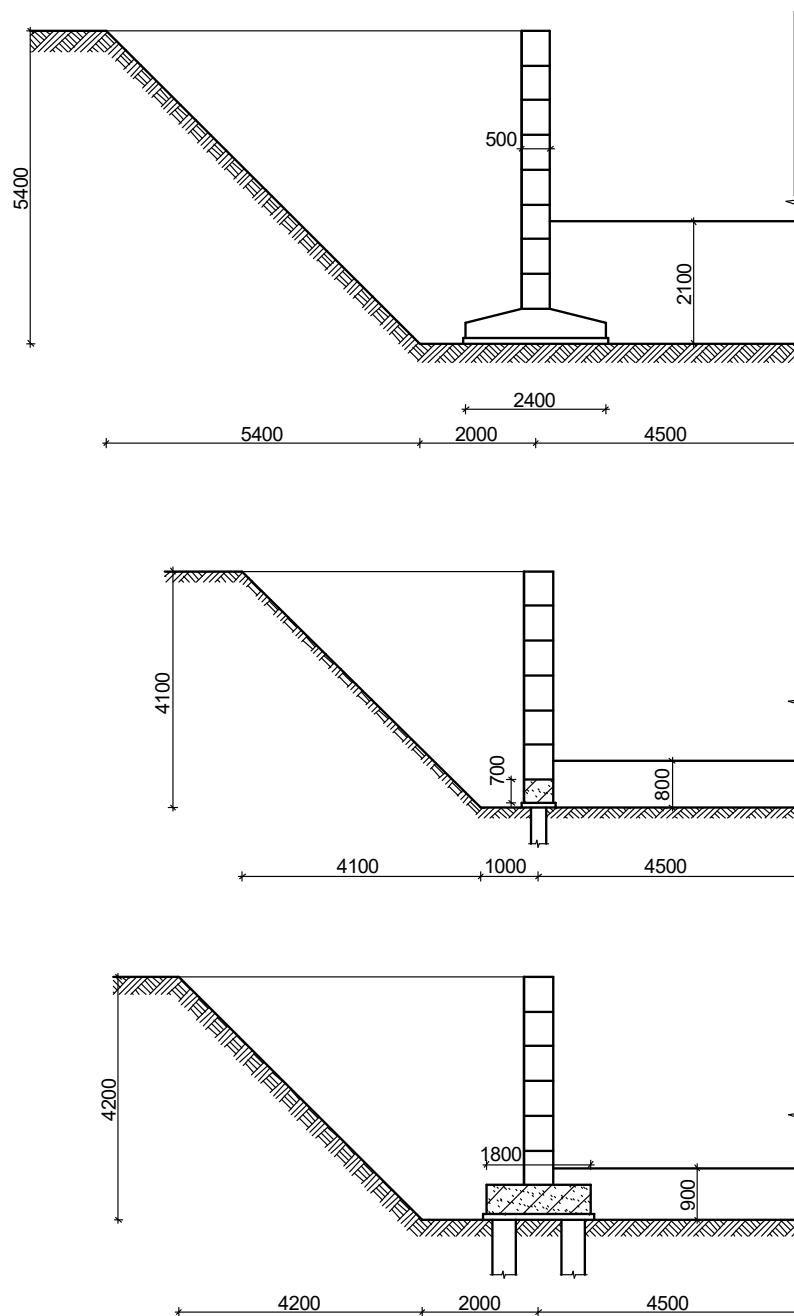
Конструктивне рішення варіантів фундаментів і поперечний переріз котловану
